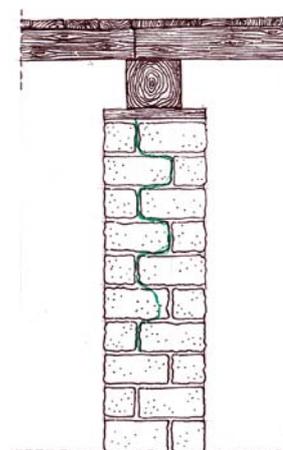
Fisuración por pandeo de una columna de adobe sobrecargada.
